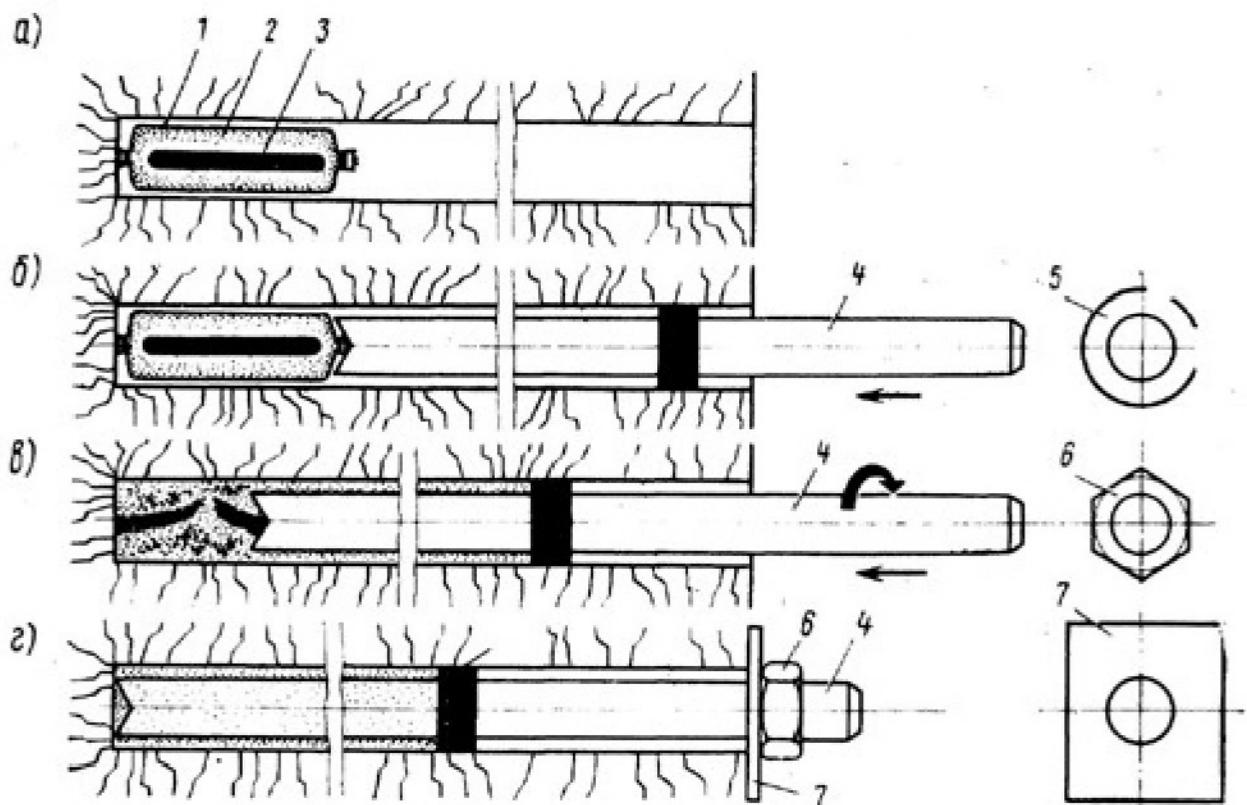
Схема установки сталеполімерного анкера:
